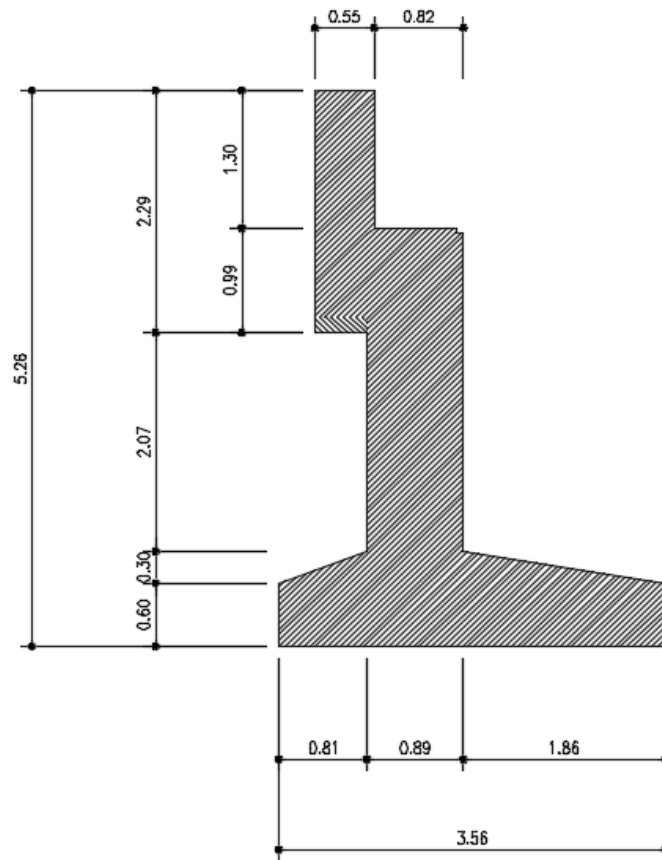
Geometria di calcolo spalla esistente
